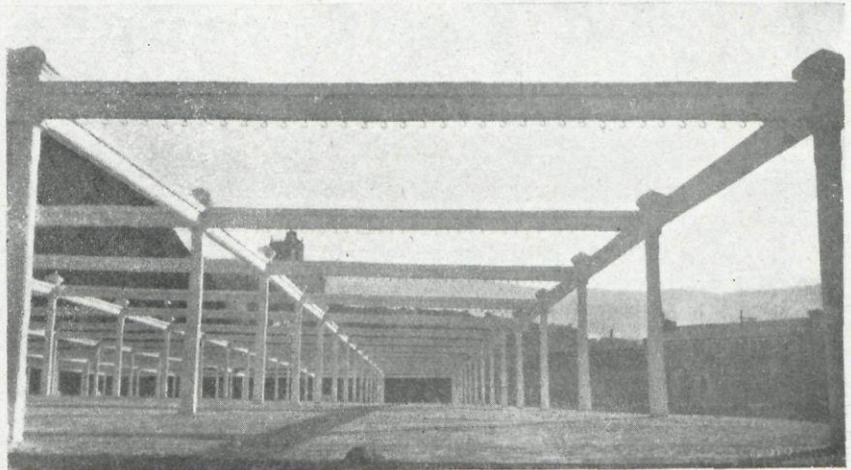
ª.—Detalle del secadero de redes de Laredo.
